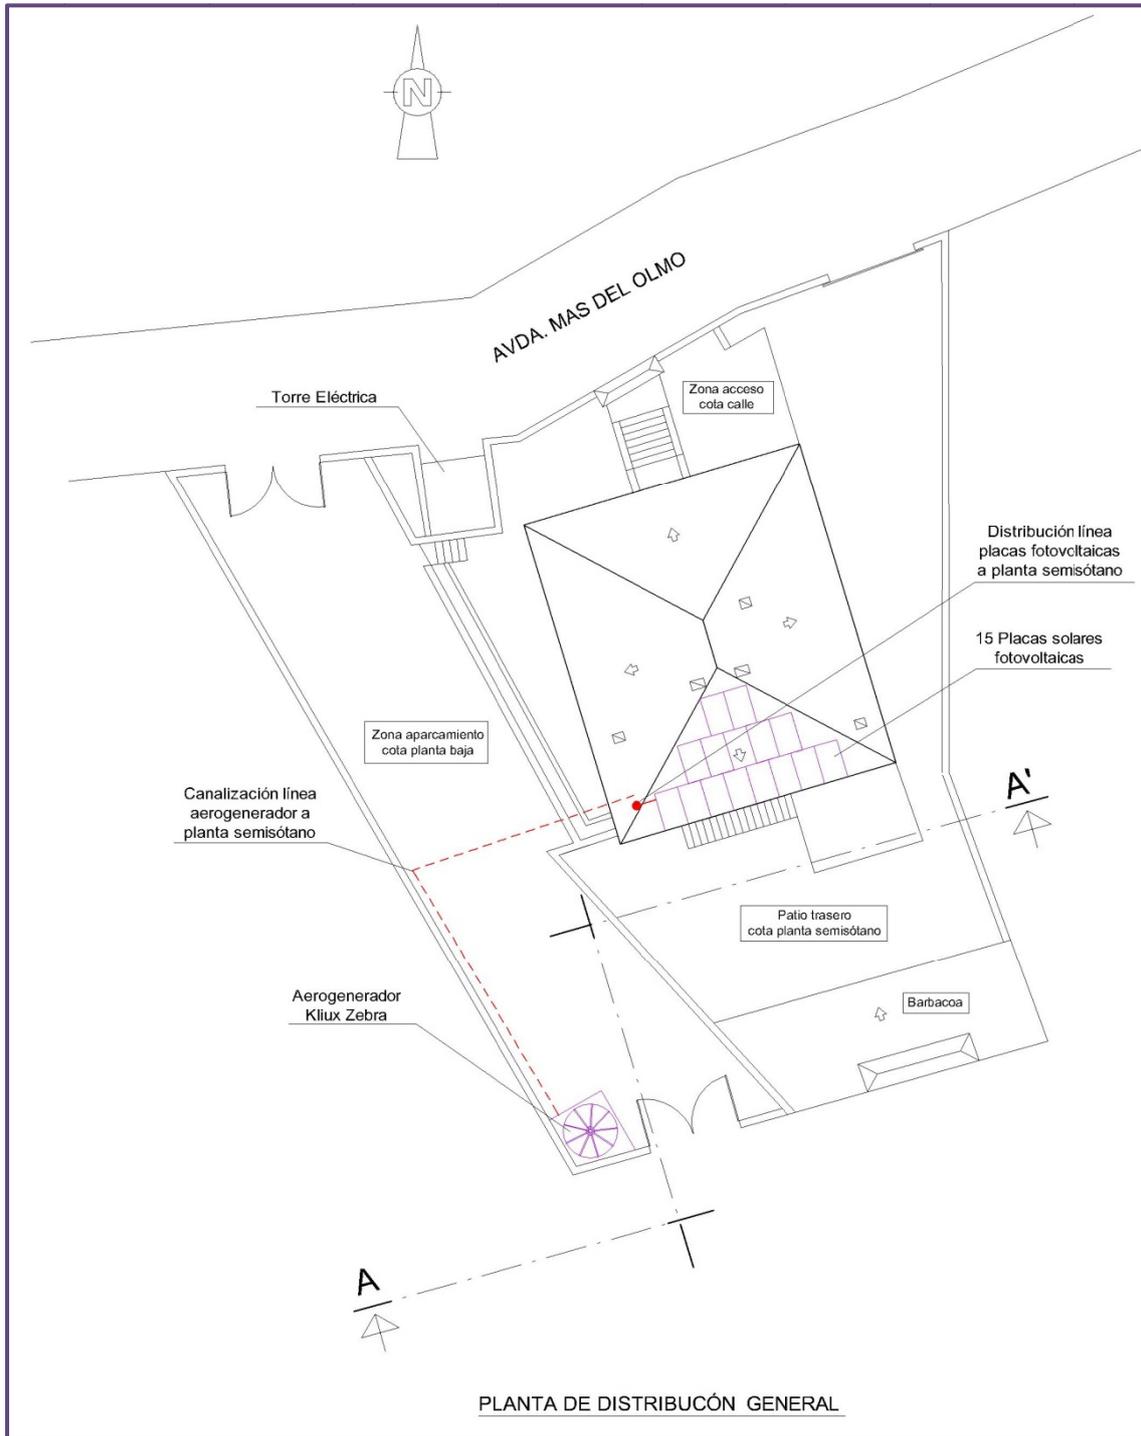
Plano planta - ubicación elementos exteriores Kliux
